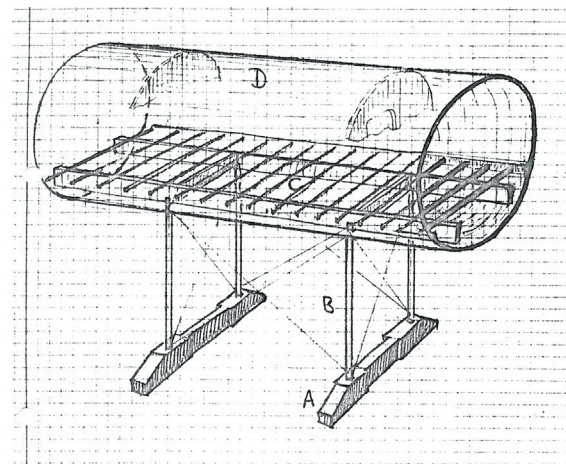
Tragsystem Röhrenhaus mit den Positionen:
